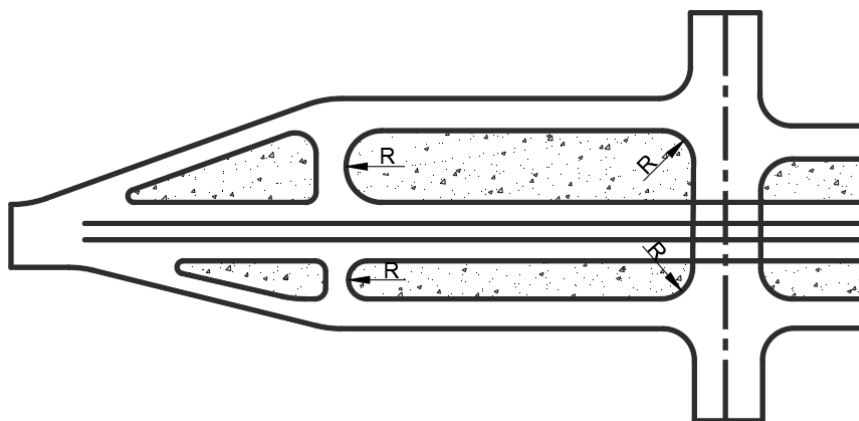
Схема развязки обжатый «клеверный лист» [9]
